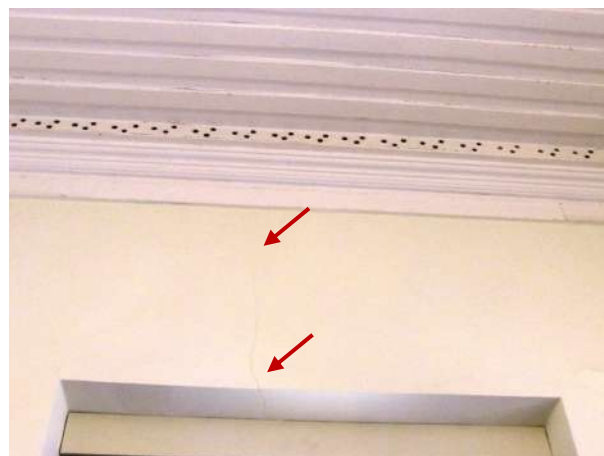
Detalhe da parede, região sobre a janela, fissurada
